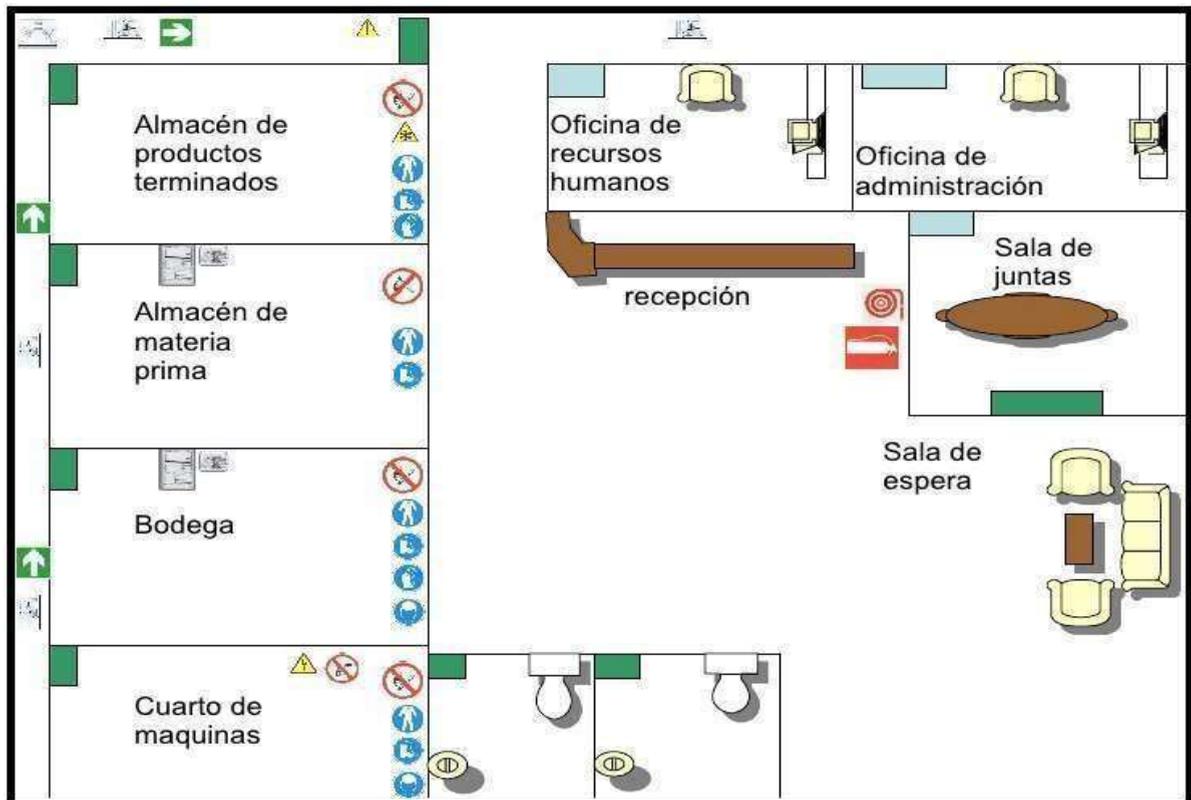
Propuesta de distribución de planta un plan “Facopa”
